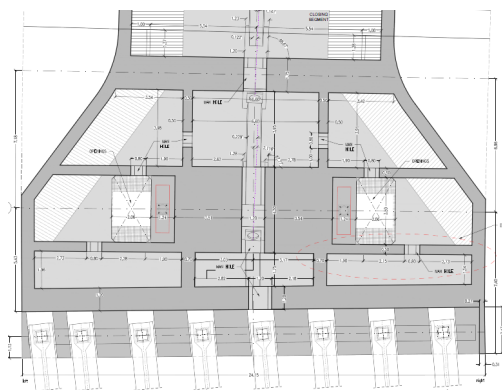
Vista de la zona transición entre puente y viaducto de acceso.
